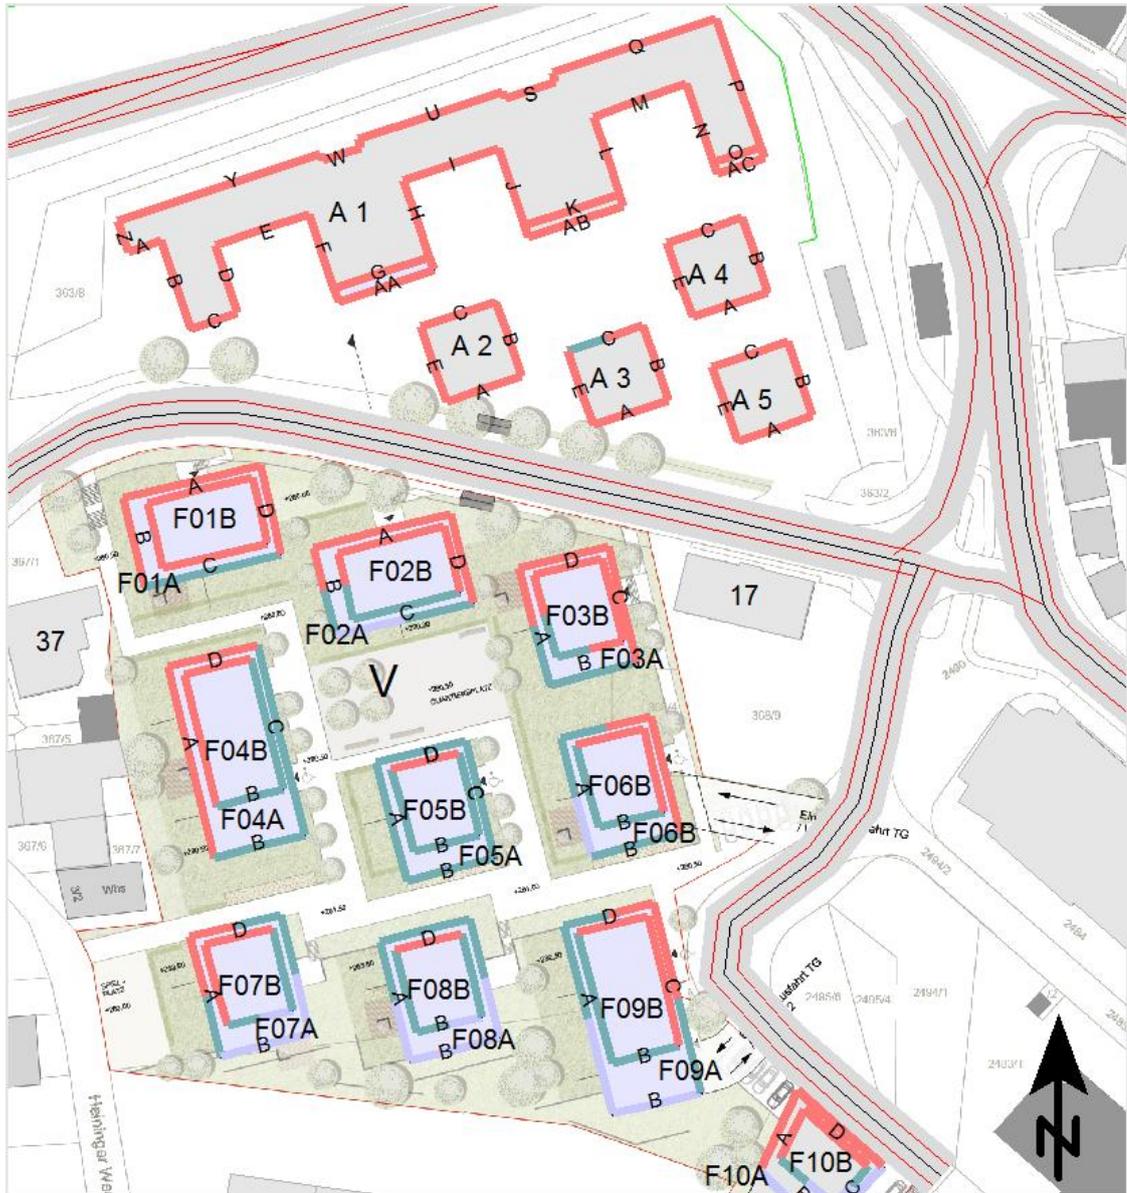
Fassaden mit einer Festsetzung und zugehörige Fassadenbezeichnung
